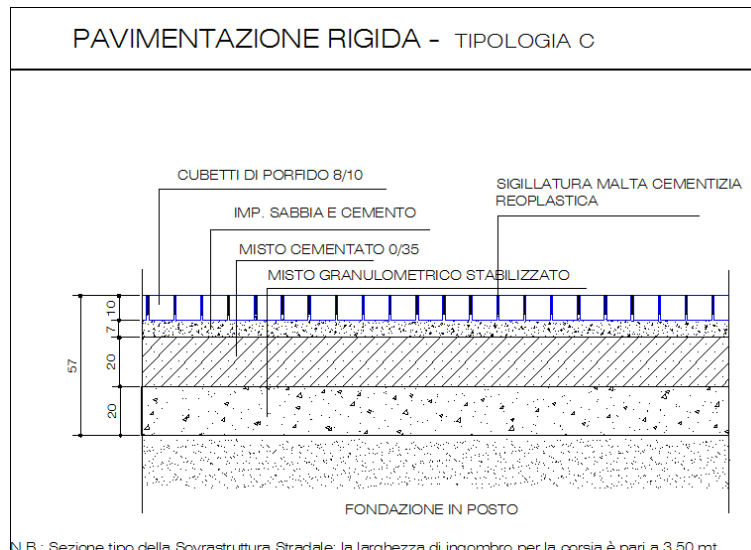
Pacchetto C: base in Misto Cementato e fondazione di 20 cm in stabilizzato granulometrico
